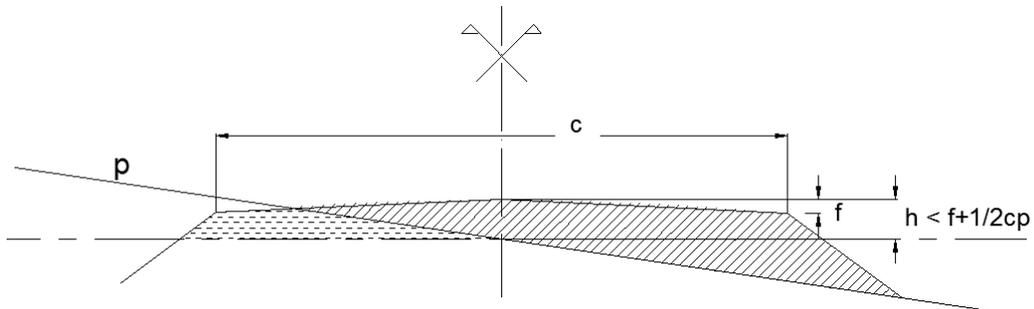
Sección transversal para $h < (f + 1/2cp)$
